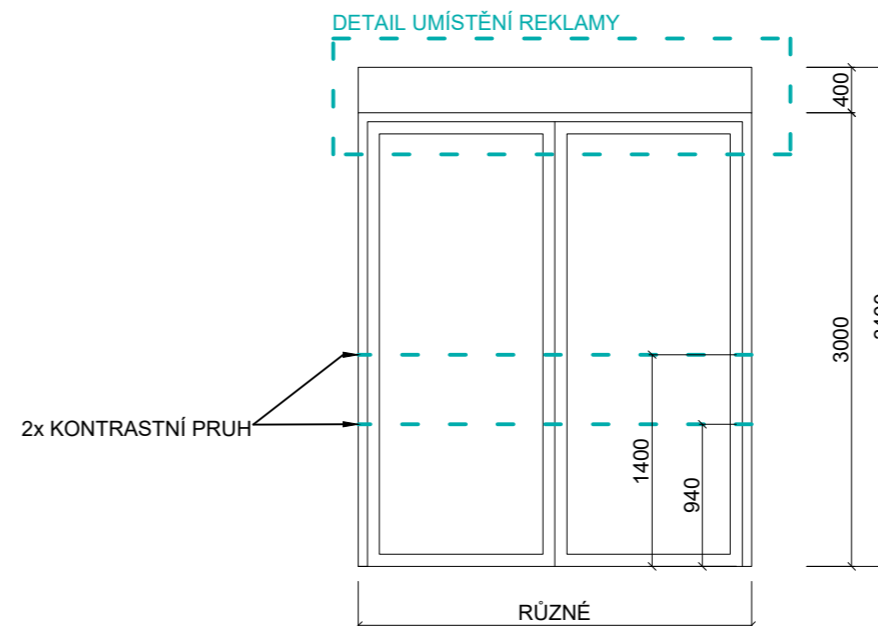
DETAIL UMÍSTĚNÍ REKLAMY 1:10
